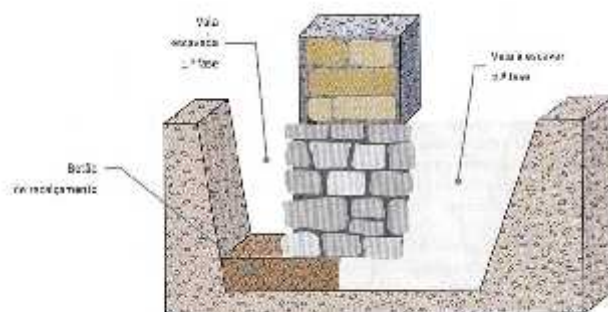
Recalcamento de fundações em alvenaria em duas fases (appleton, 2003).
